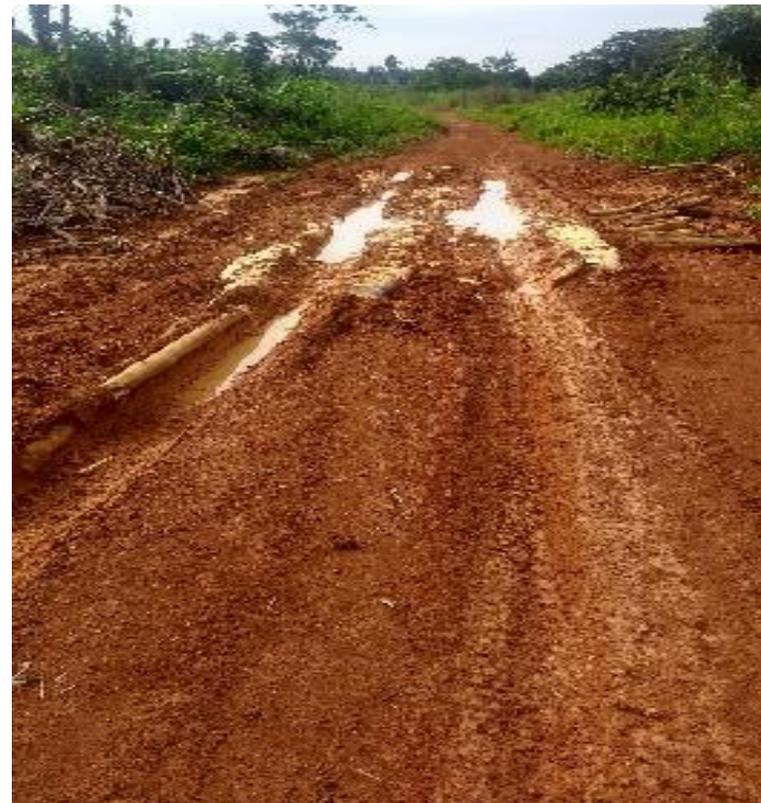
Tramo priorizado para construcción de Placa Huella K5+072 Long = 179 m
